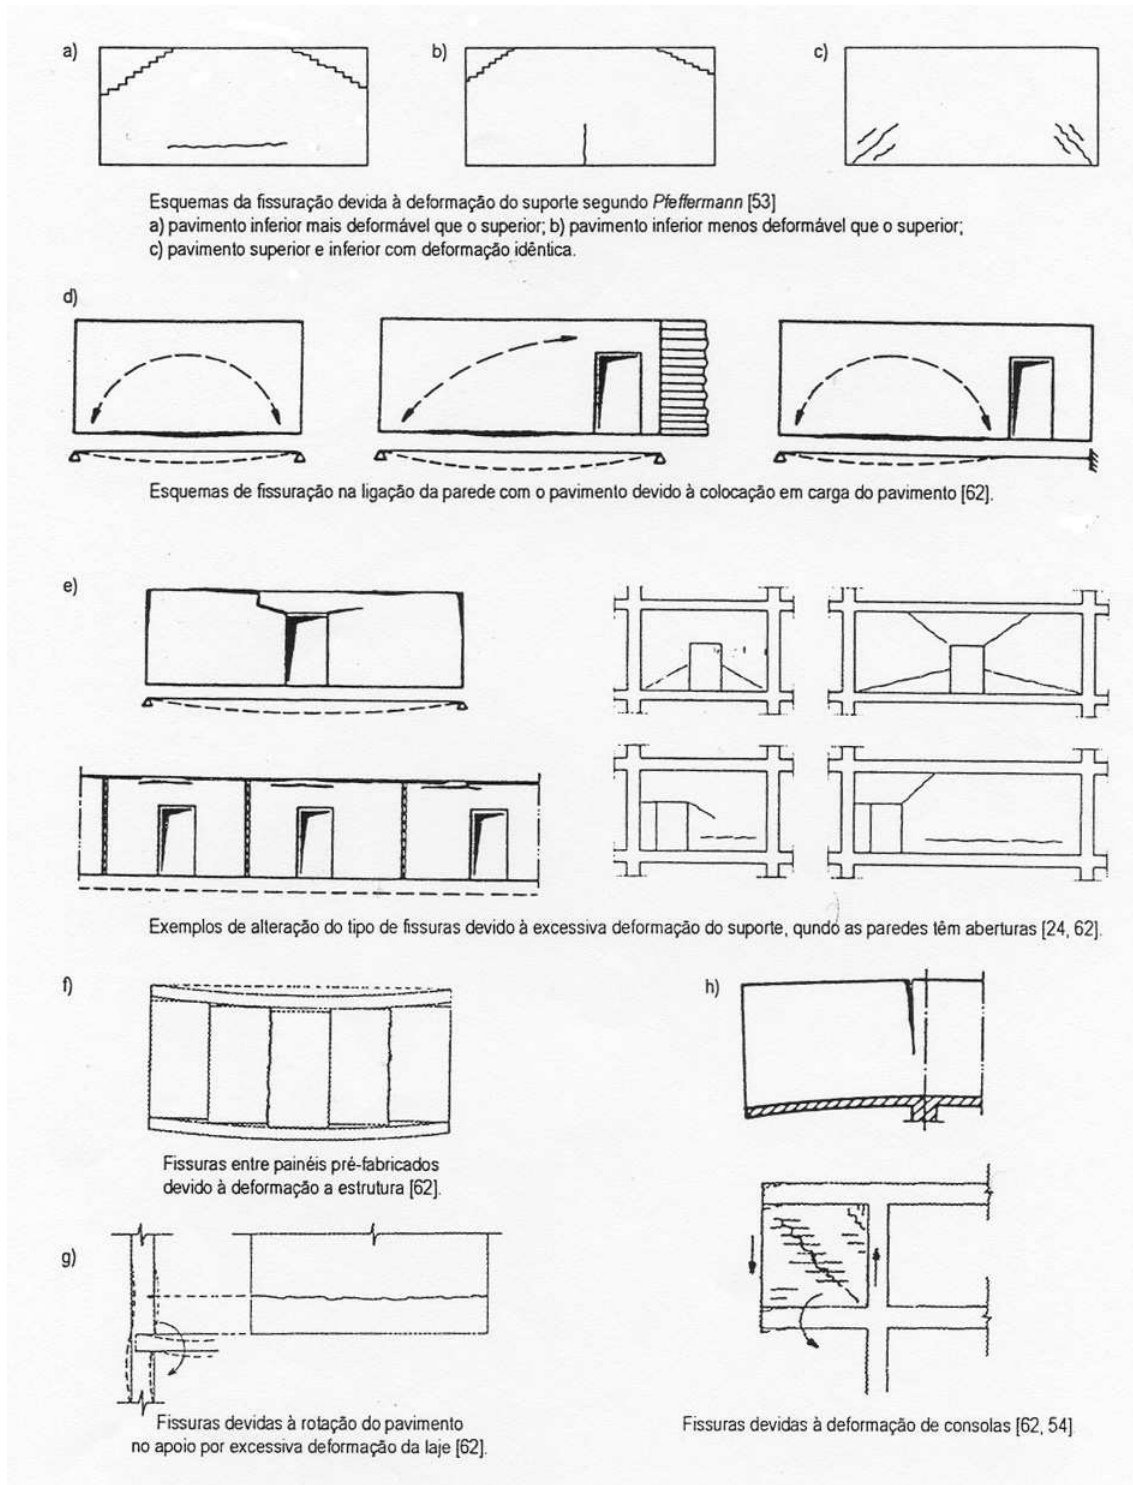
Exemplos de fissuração devida à deformação excessiva do suporte [5]
